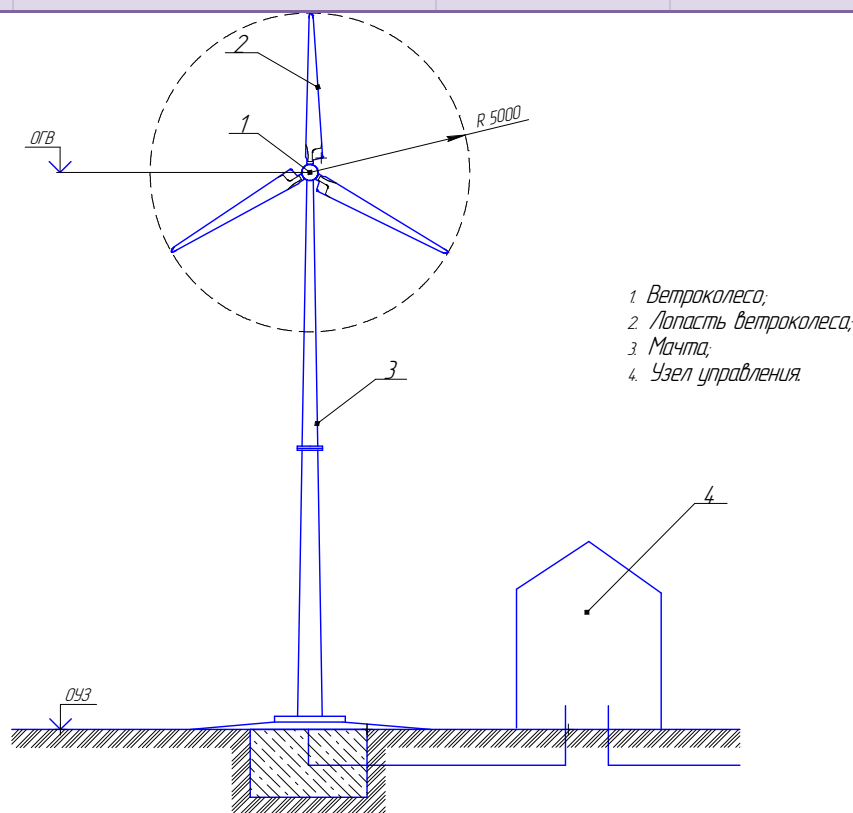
Схема ветроэнергетической установки с начальными конструктивными размерами
